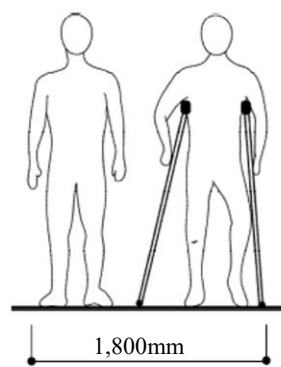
4 Dimension de croisement des utilisateurs de béquilles et des passants
